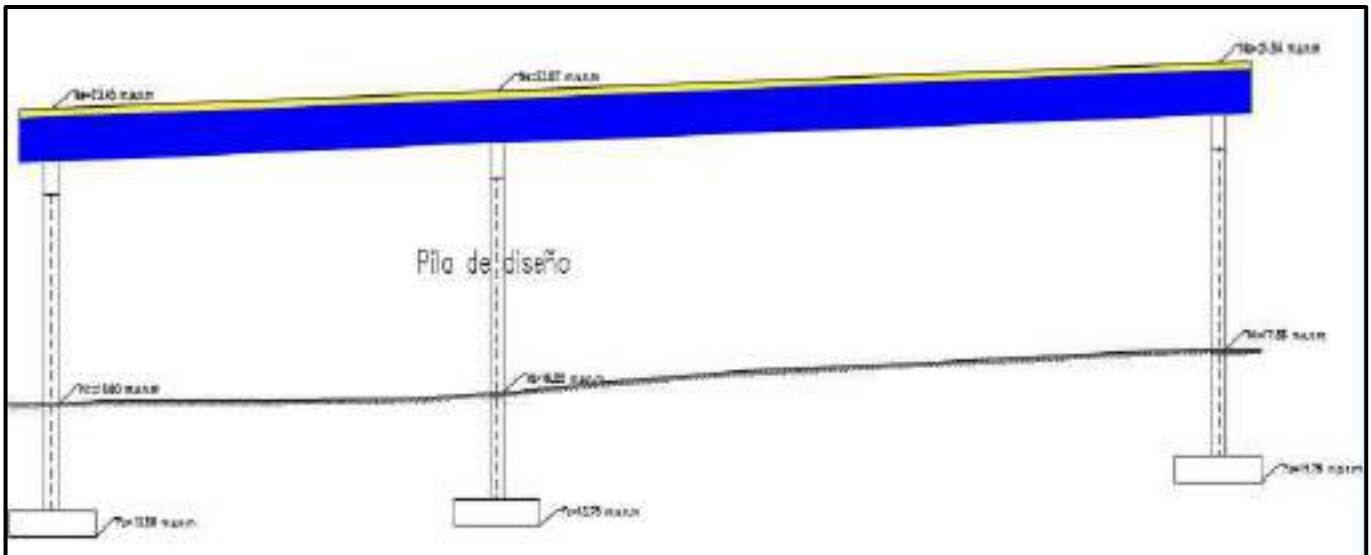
Vista de perfil de la pila de diseño y las pilas contiguas
